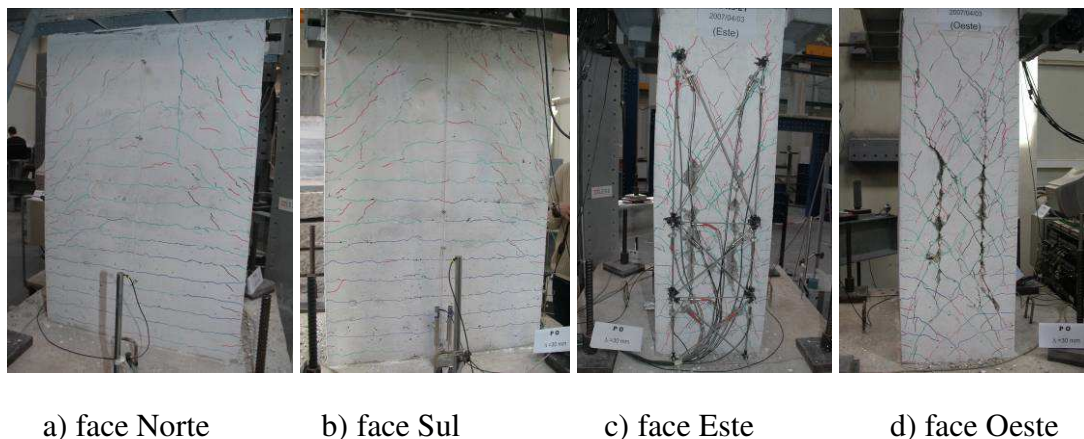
Dano do pilar PO2-N5 no final do ensaio
